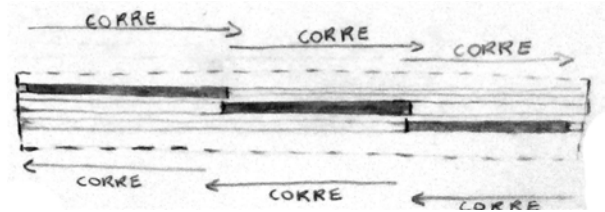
Imagemplanta demonstrando a movimentação das placas.
